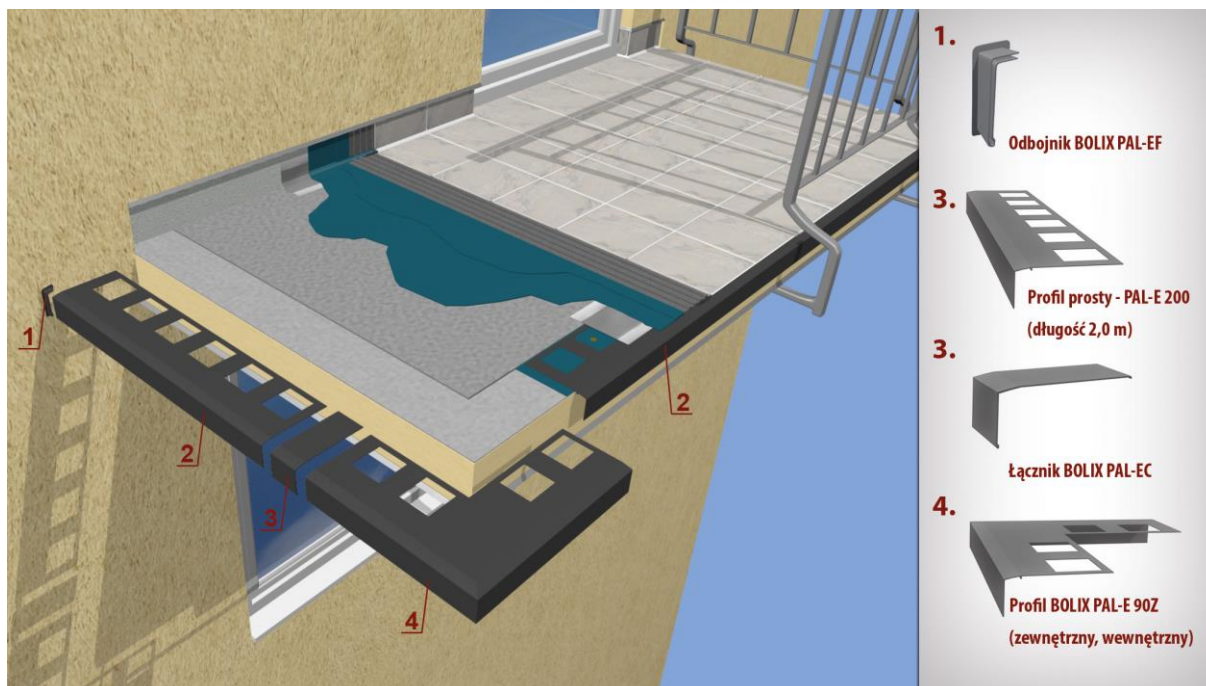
Wyprofilowanie zewnętrznych krawędzi balkonu w warstwie spadkowej.
